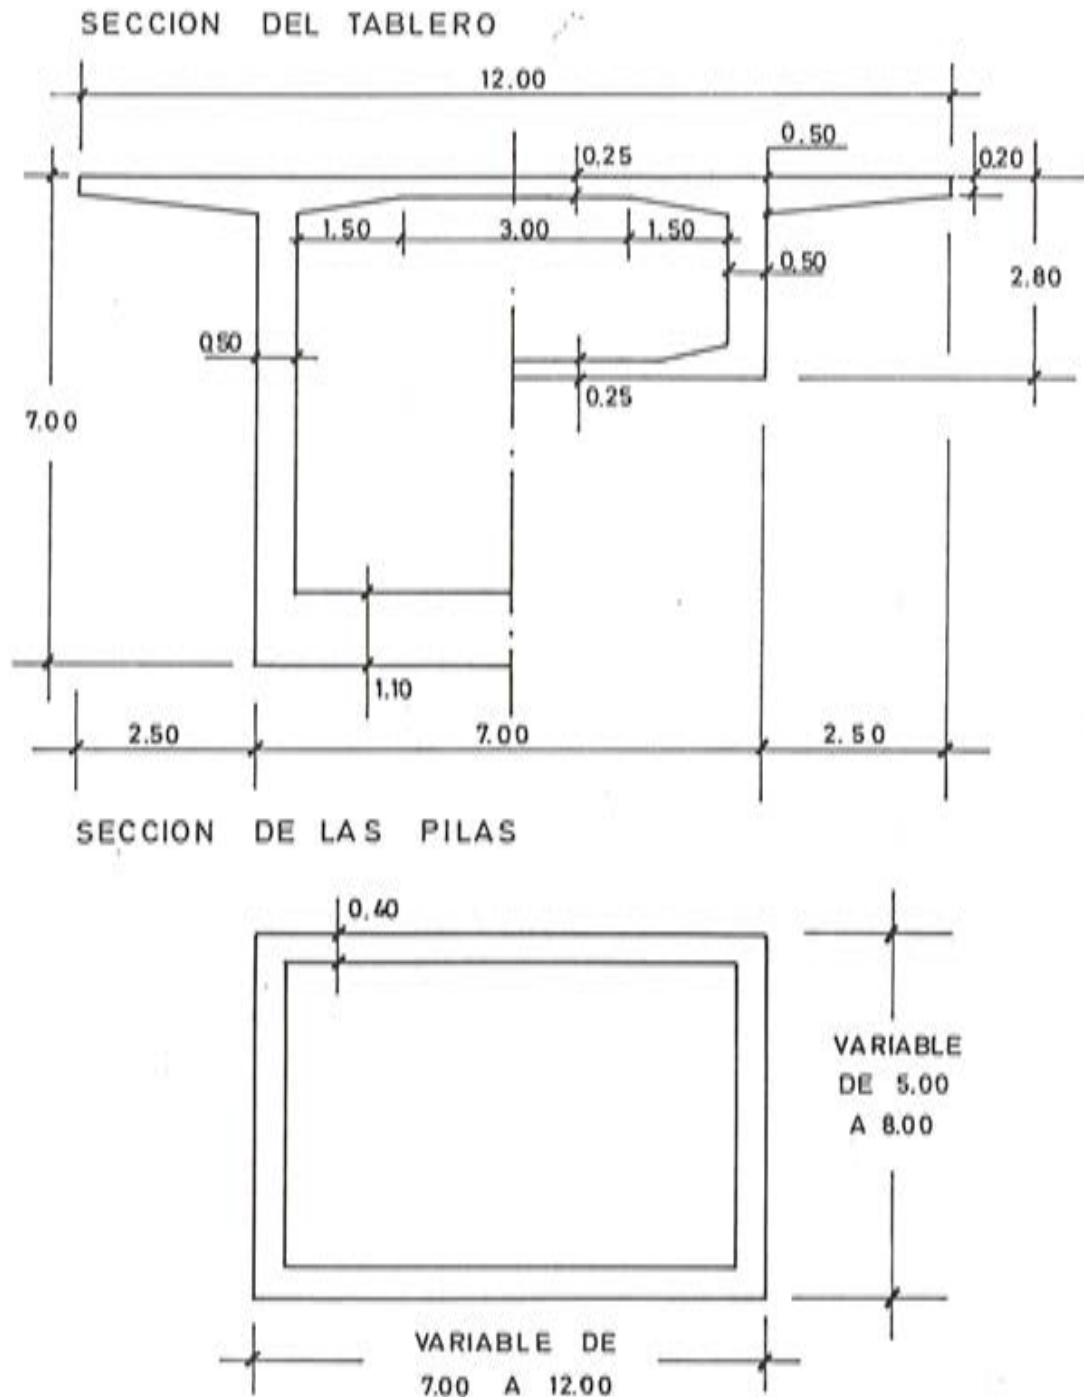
Secciones del dintel y de las pilas del viaducto analizado en primer lugar y definido en la figura 5.
